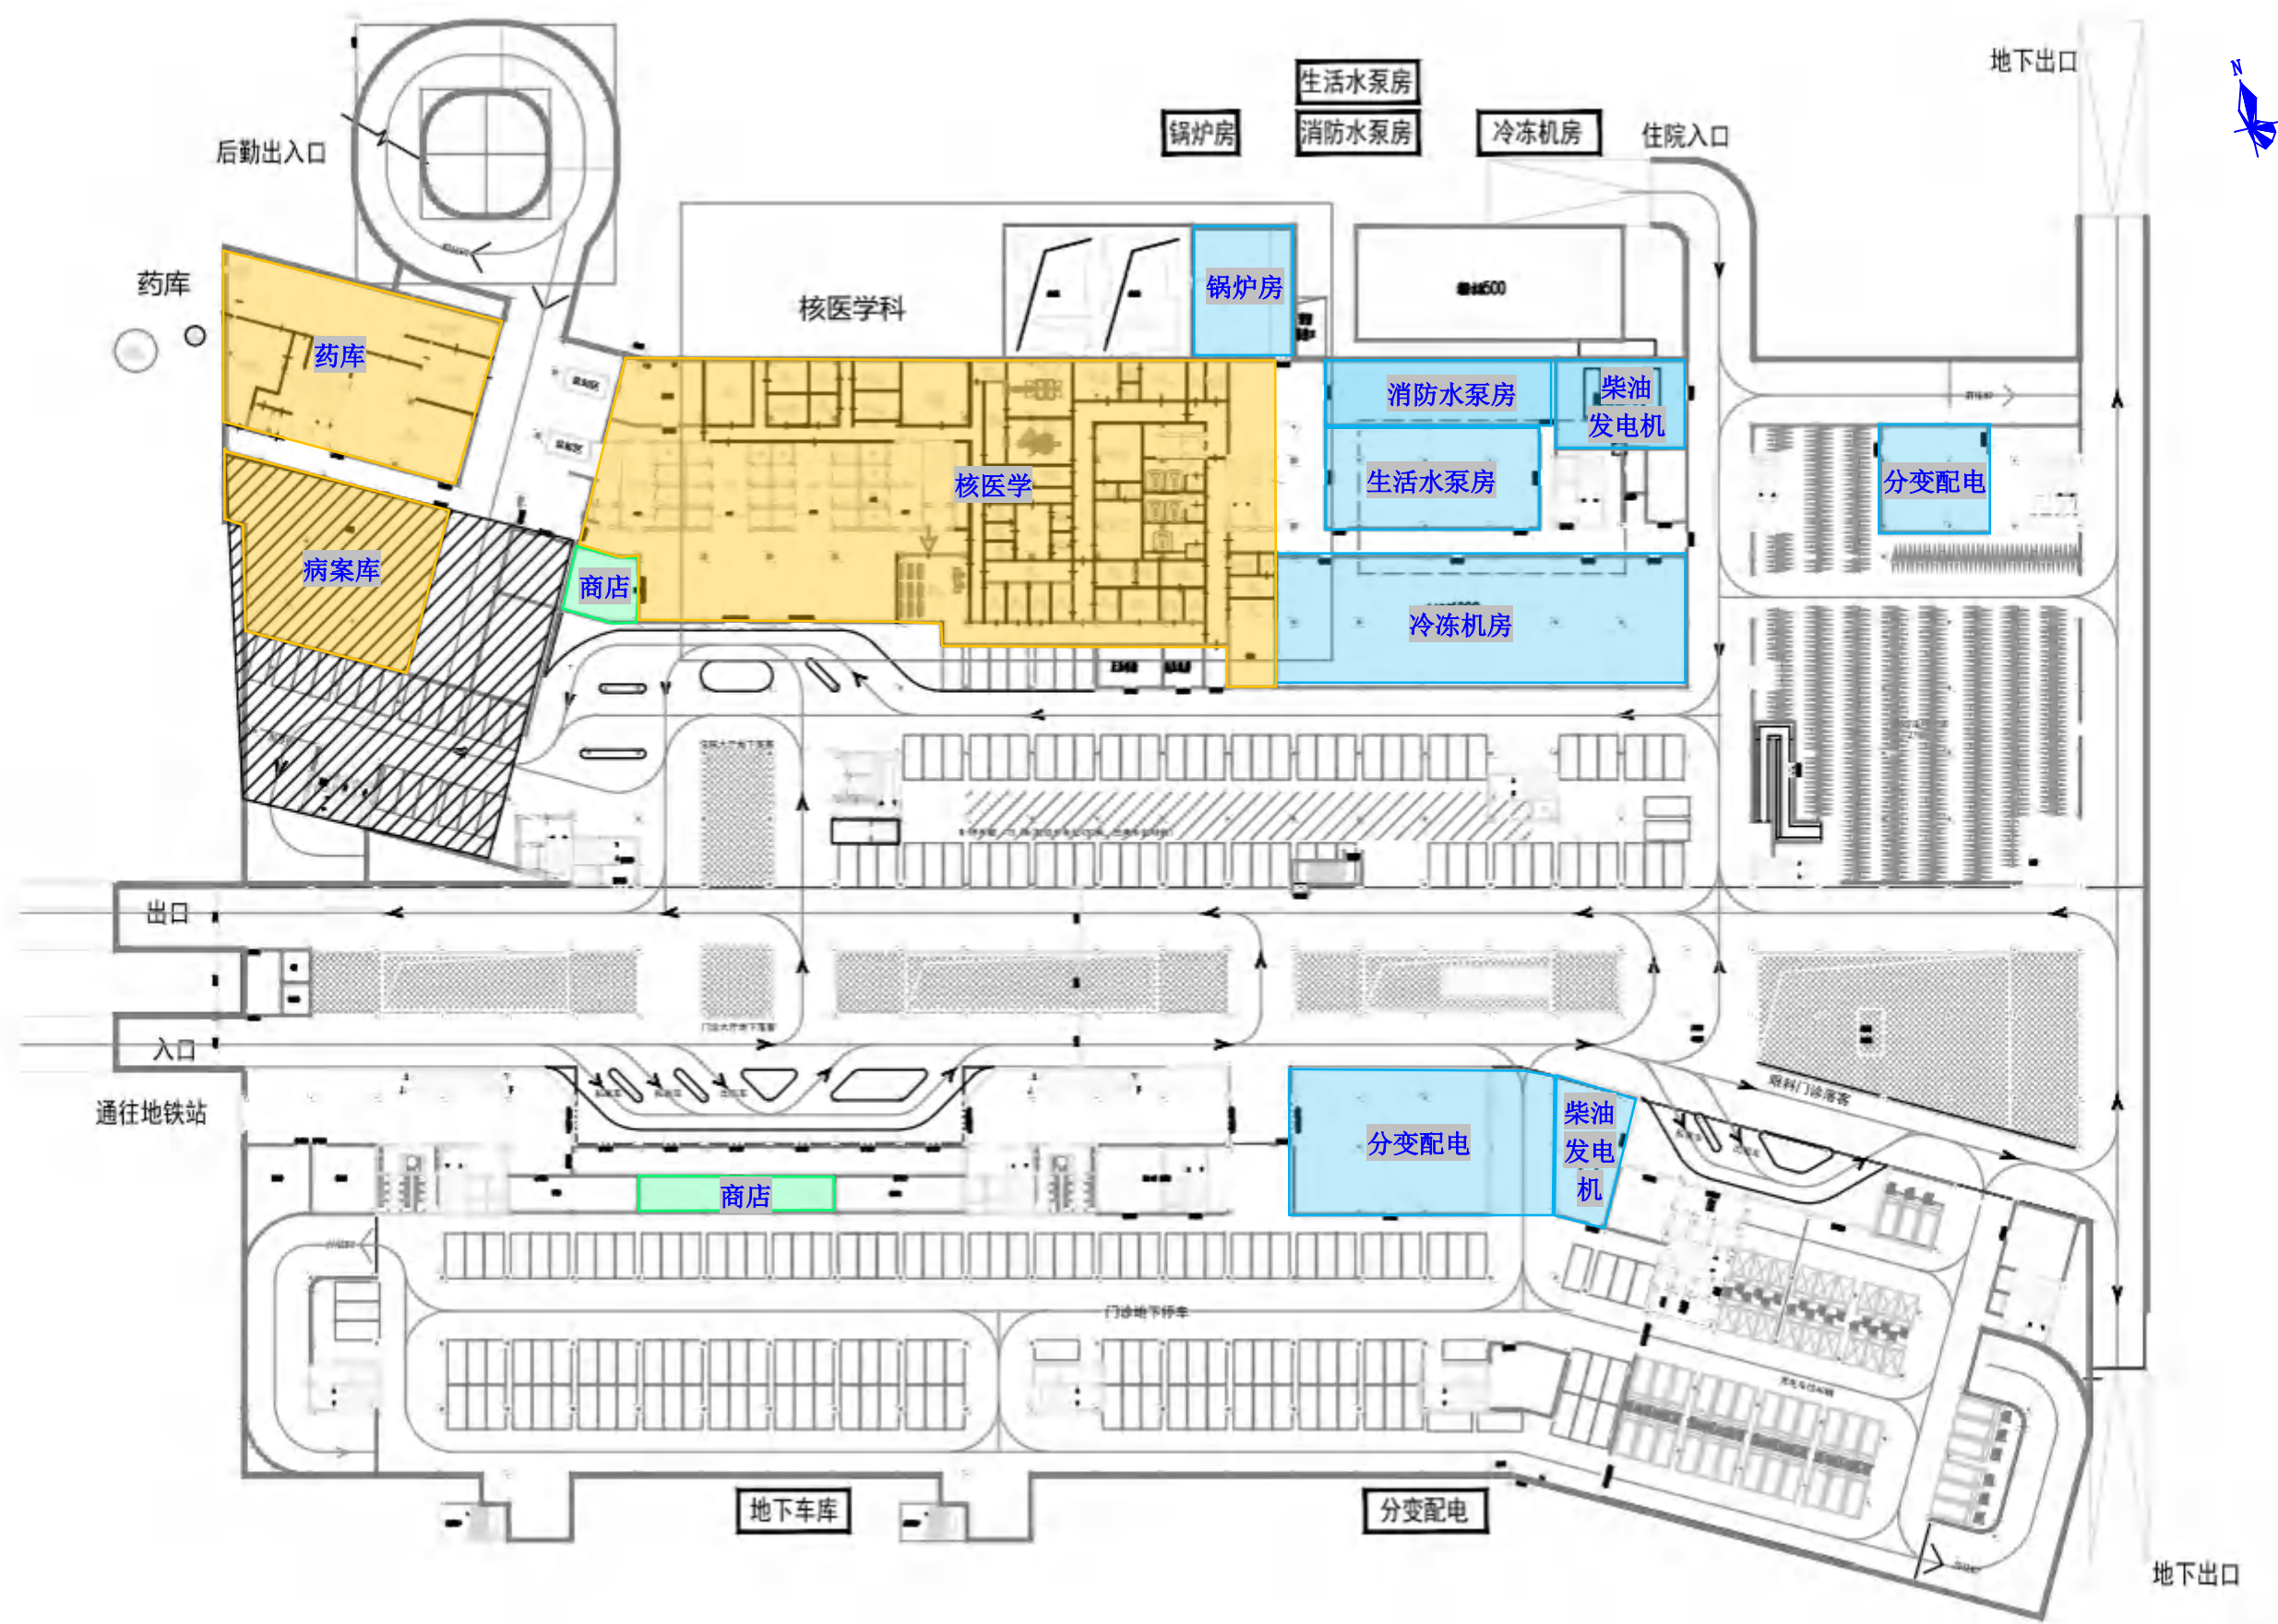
项目医疗综合楼地下负一层平面布置图（比例尺：1464）
